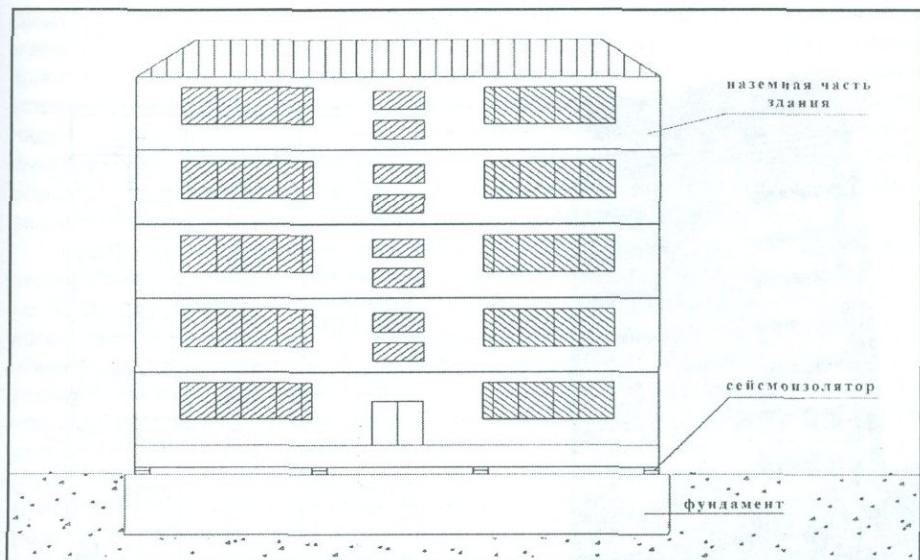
(10) Схема здания, укрепленного сейсмоизоляторами (резинOMETаллические опоры).
